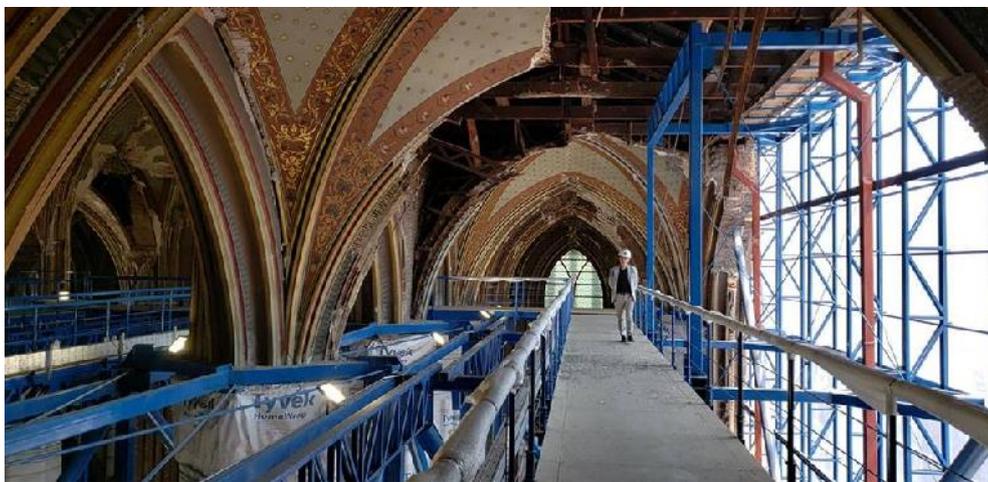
Muro poniente y techos colapsados de la Basílica del Salvador.
